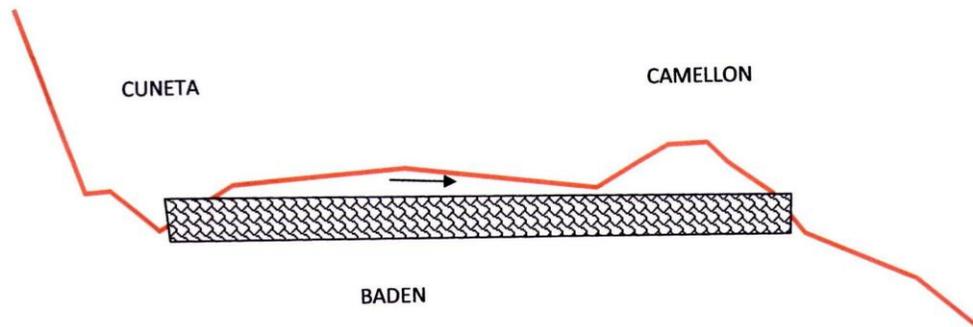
SECCION CAMINO DE ACCESO CON SUS DRENAJES
